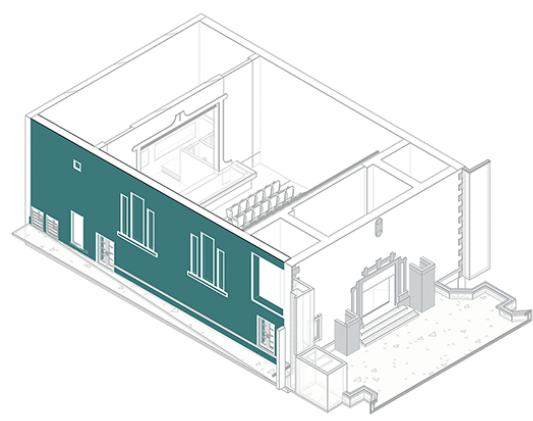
Maqueta virtual que señala vanos obstruidos en fachada norte del teatro. Fuente: modelo realizado por Arq. Nelson López y detallado por Arq. Eleany Flores
